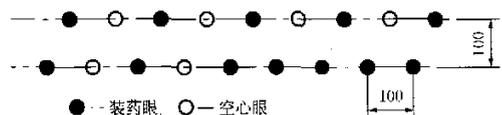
厚钢筋混凝土结构切割爆破炮眼布置图
